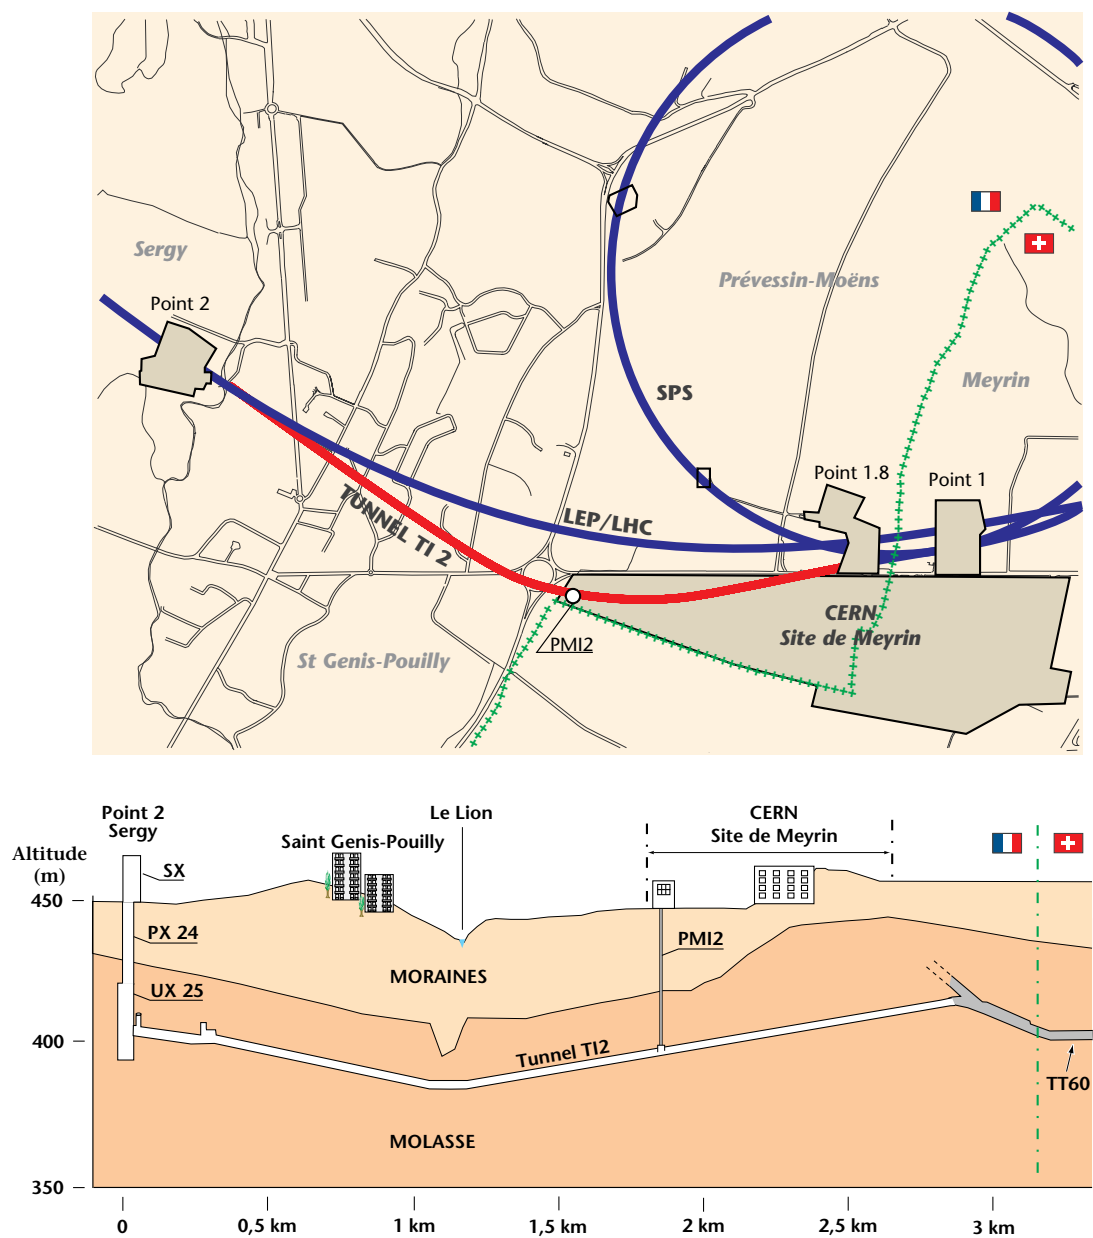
Plan de situation et profil longitudinal du tunnel de transfert TI 2
